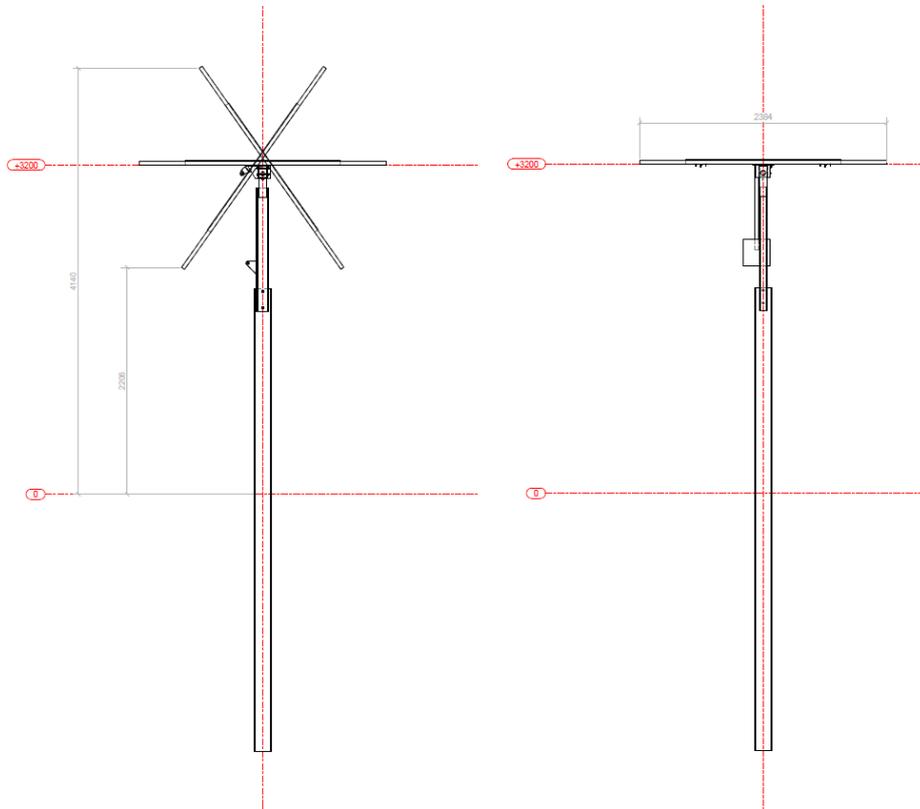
Esempio struttura sostegno moduli con palo di fondazione che raggiunge una profondità di 2 m. Altezza massima raggiunta 4,14 m.
